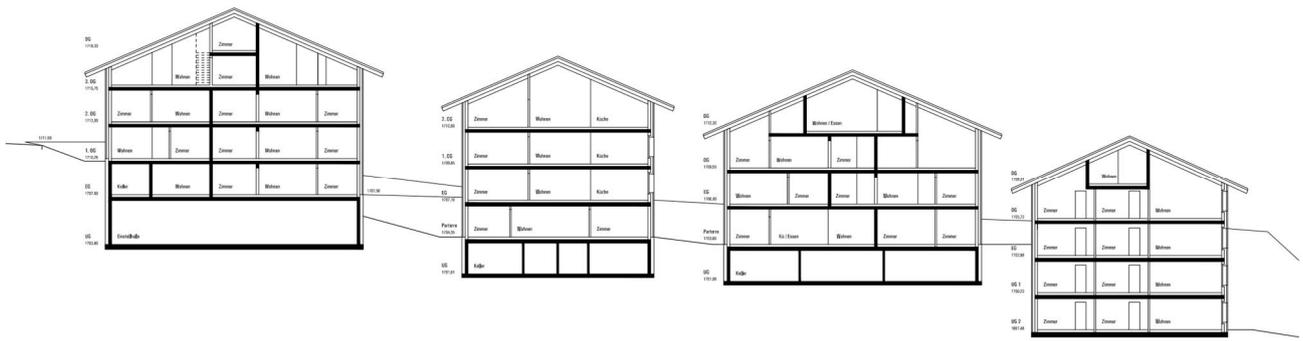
Längsschnitt z'Hengert gan (massstabslos)
